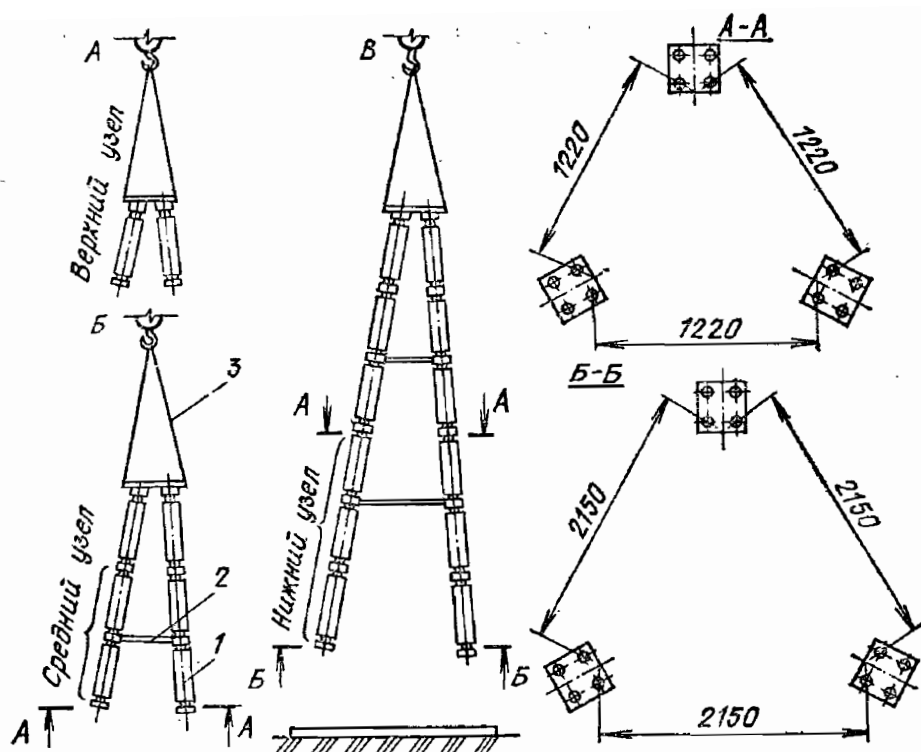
Схема укрупнительной сборки опорной изоляции разъединителя:
